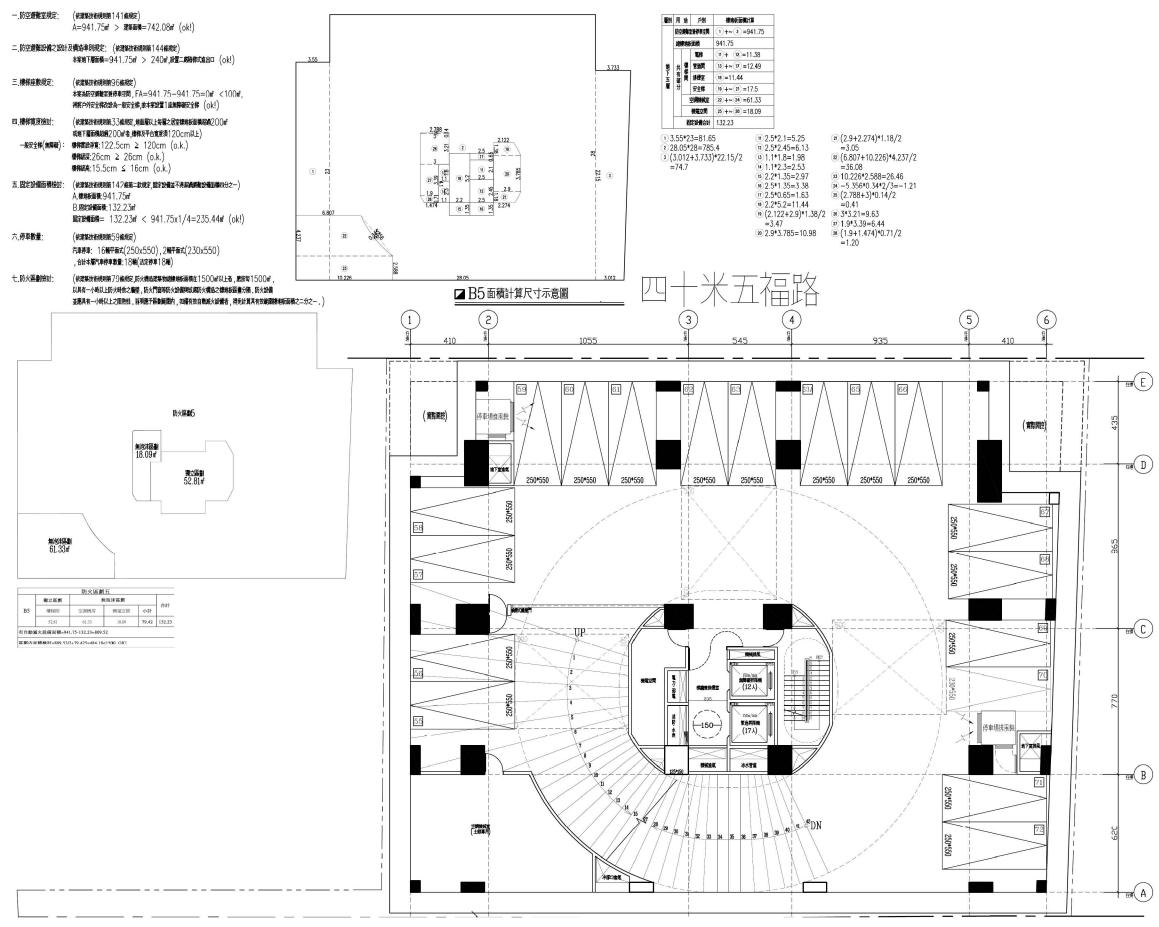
地下 5 層平面圖 (比例尺 1/200)
